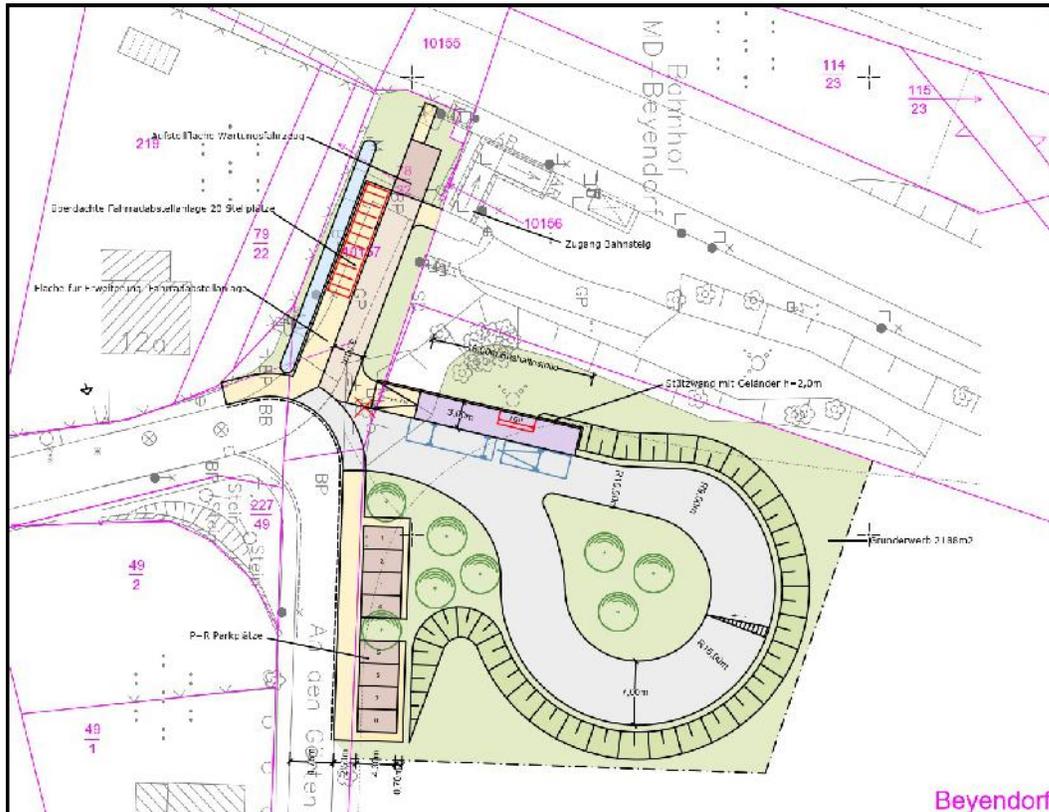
Lageplanvariante 1a - Wendeschleife
